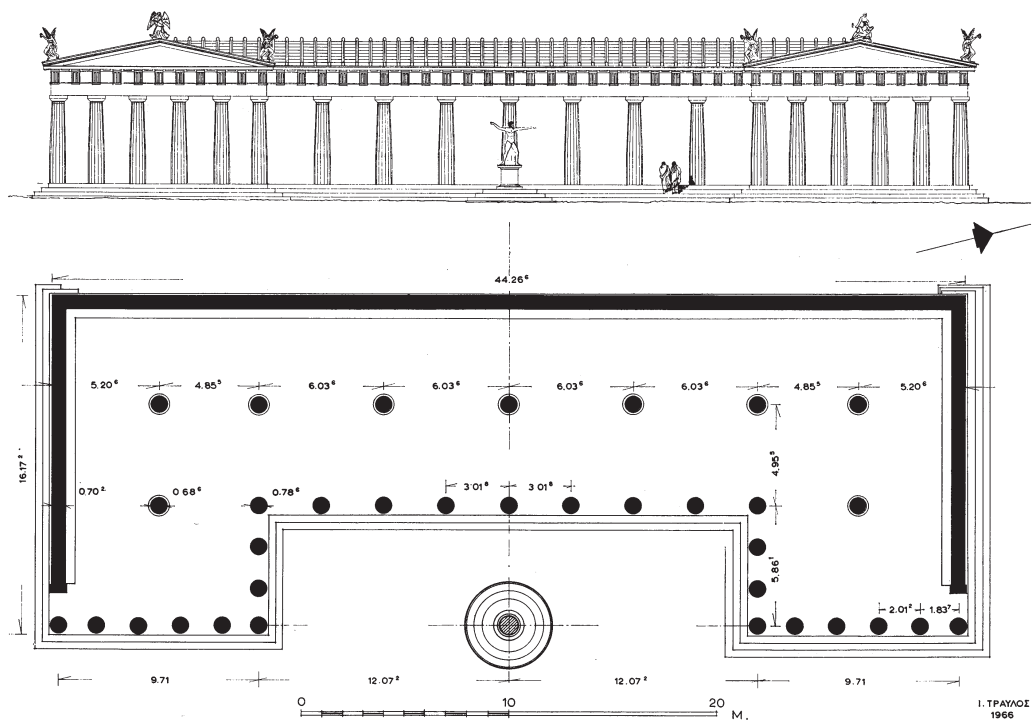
Athen, Zeusstoa: Rekonstruktion von Aufriss und Grundriss. – (Nach Travlos 1971, 529 Abb. 666).
